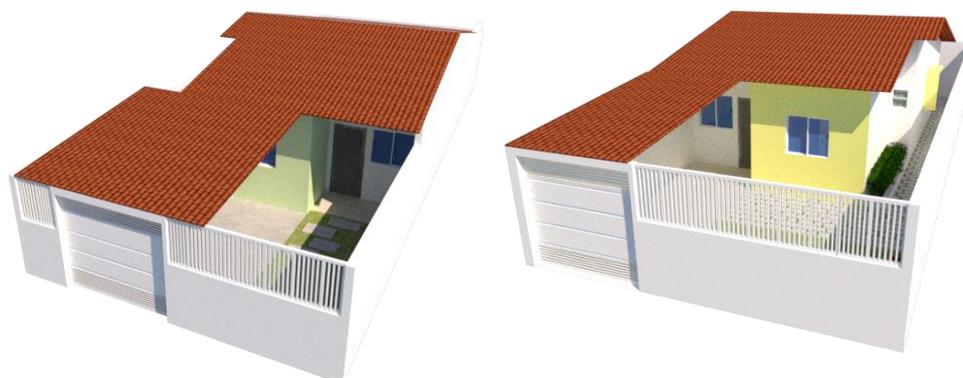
Proposta orientada à Noroeste - Fachada frontal
